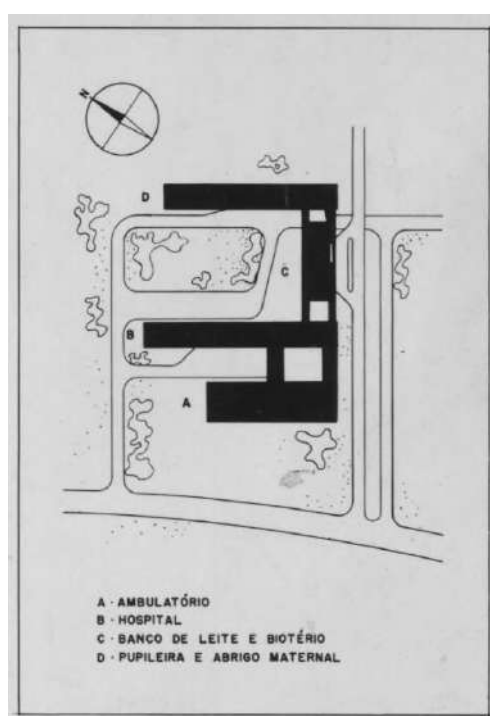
Planta de situação original do IPPMG. Fonte: NPD-FAU.
